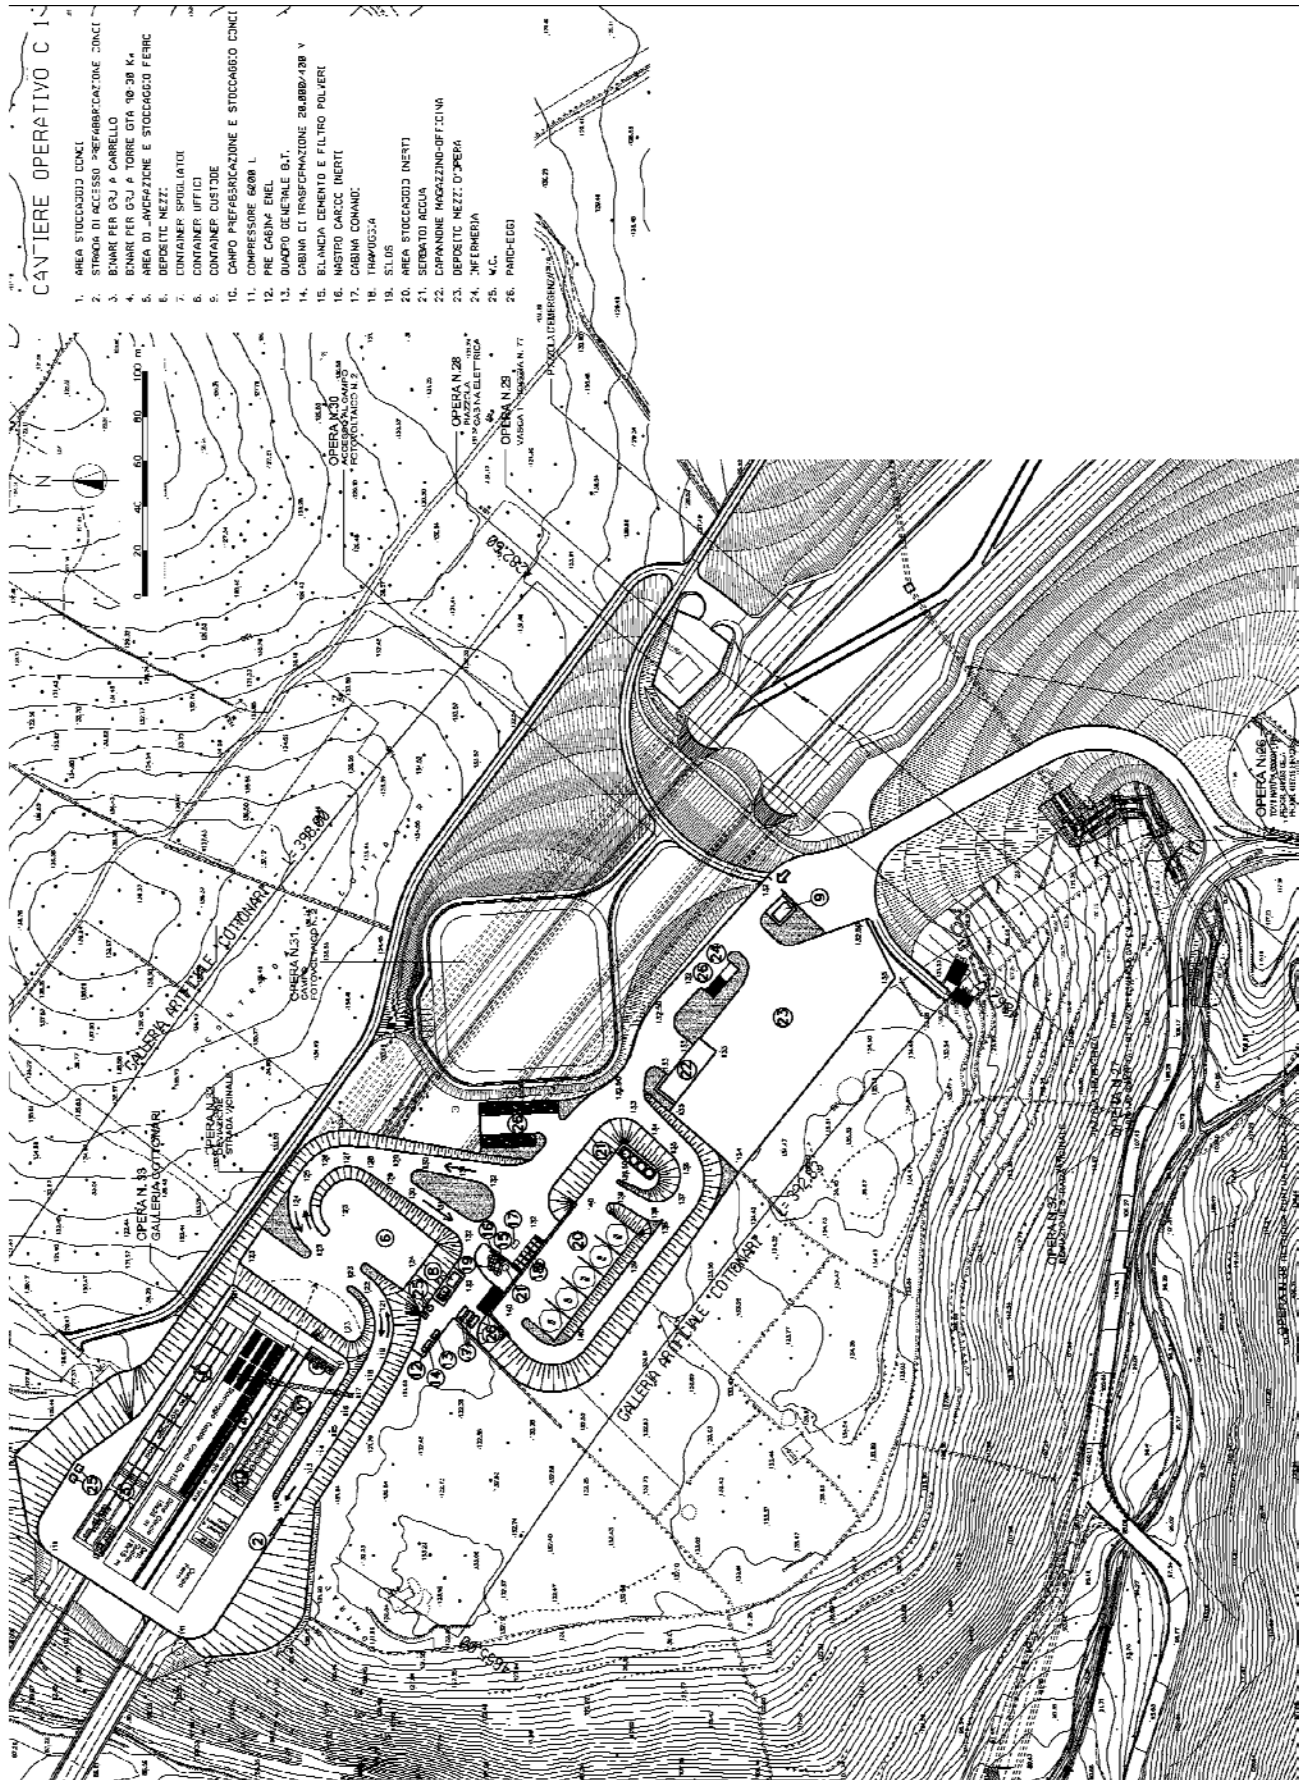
Cantiere C.1 – Planimetria schematica
